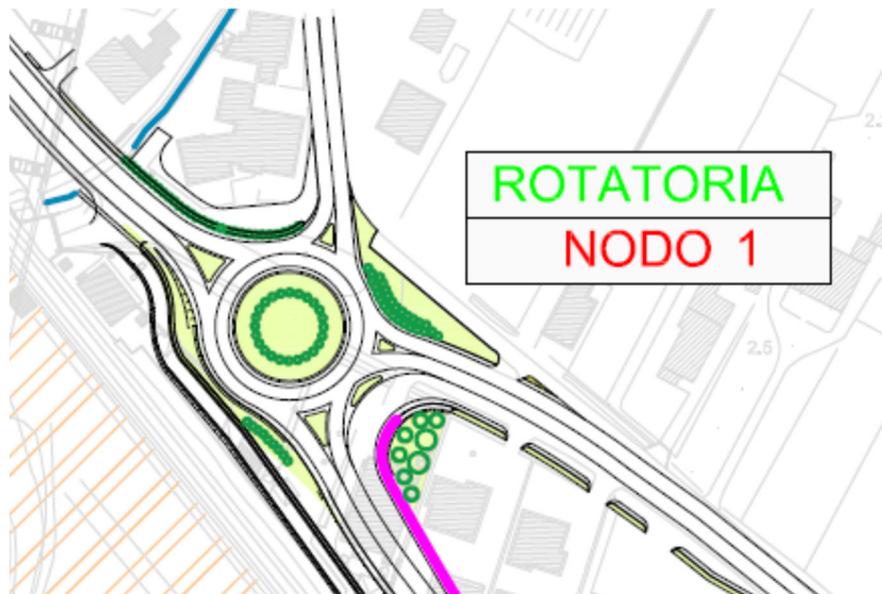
Nodo 1 particolare delle mitigazioni in planimetria
